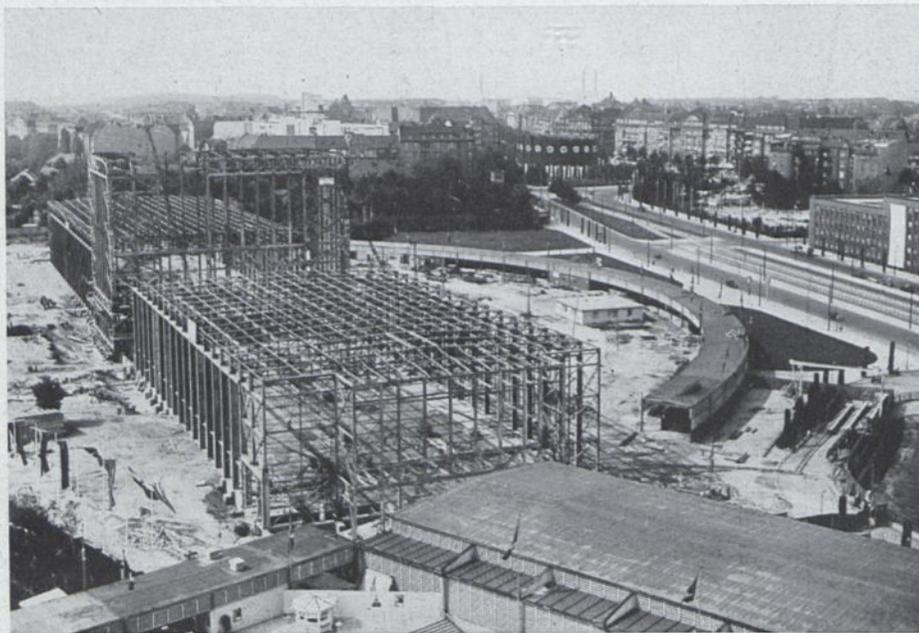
Blick vom Funkturm auf die Halle. Im Vordergrund die vorhandene Halle VIII.
